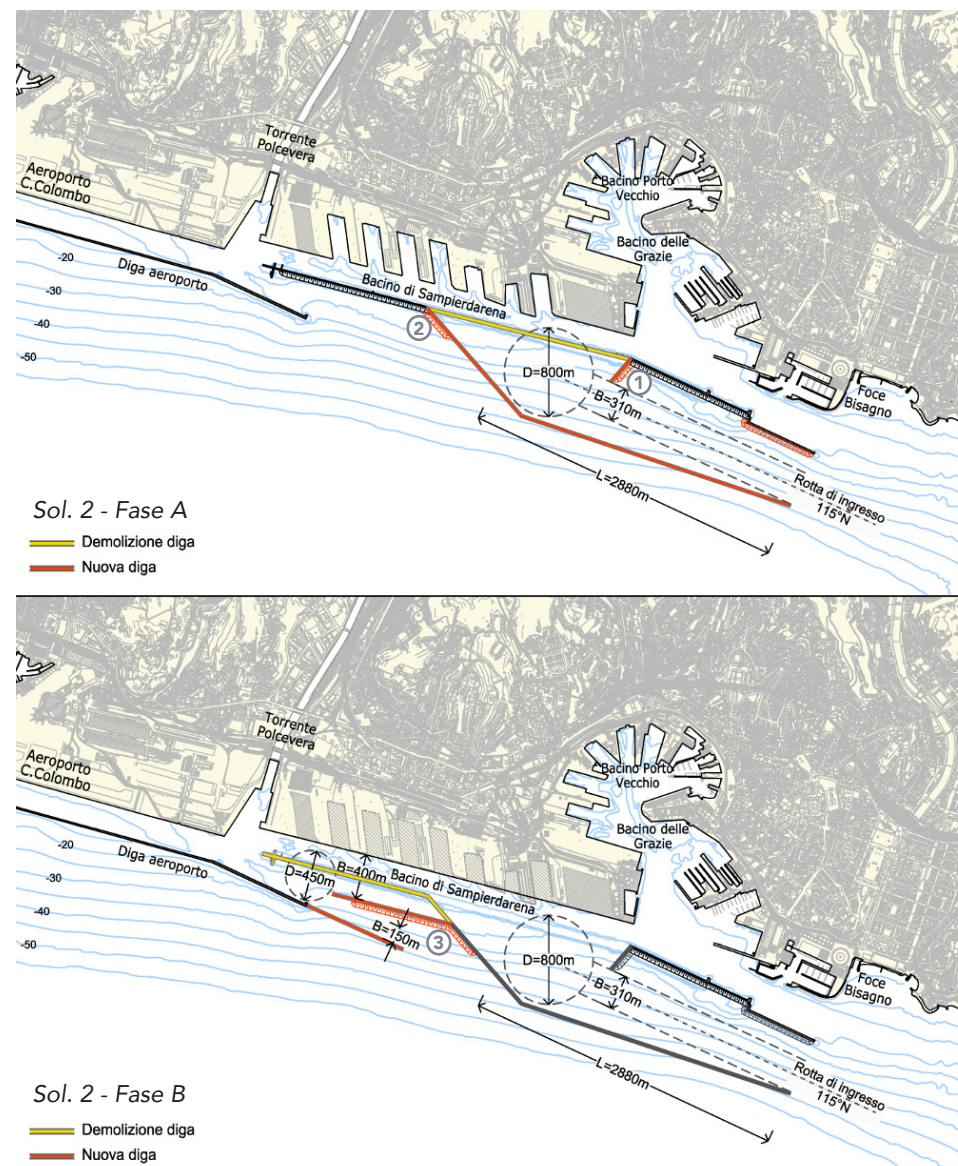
Soluzione alternativa d'intervento n. 2 – fasi funzionali a) e b) di costruzione
